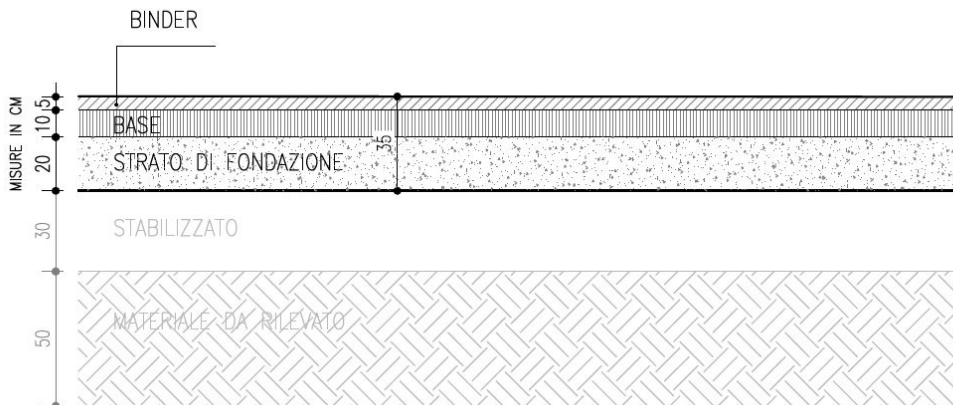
Esempio di pavimentazione di cantiere ripristinata
